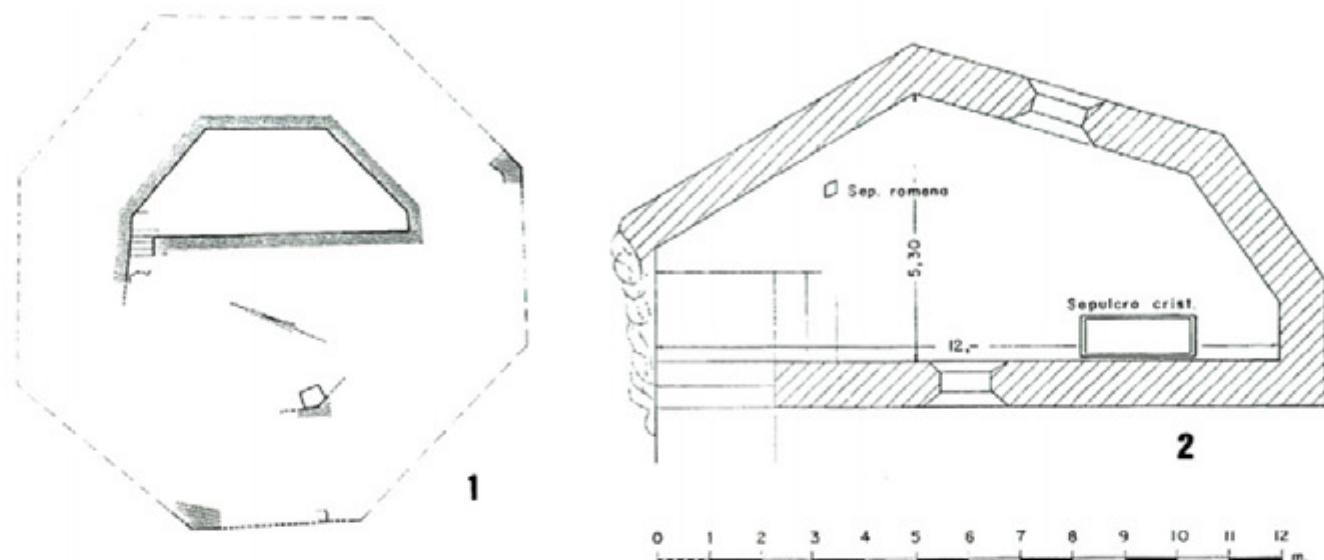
Las Vegas de Pueblanueva (Toledo): 1.- Planta del mausoleo 2.- Planta de la cripta, según Fernández Galiano
